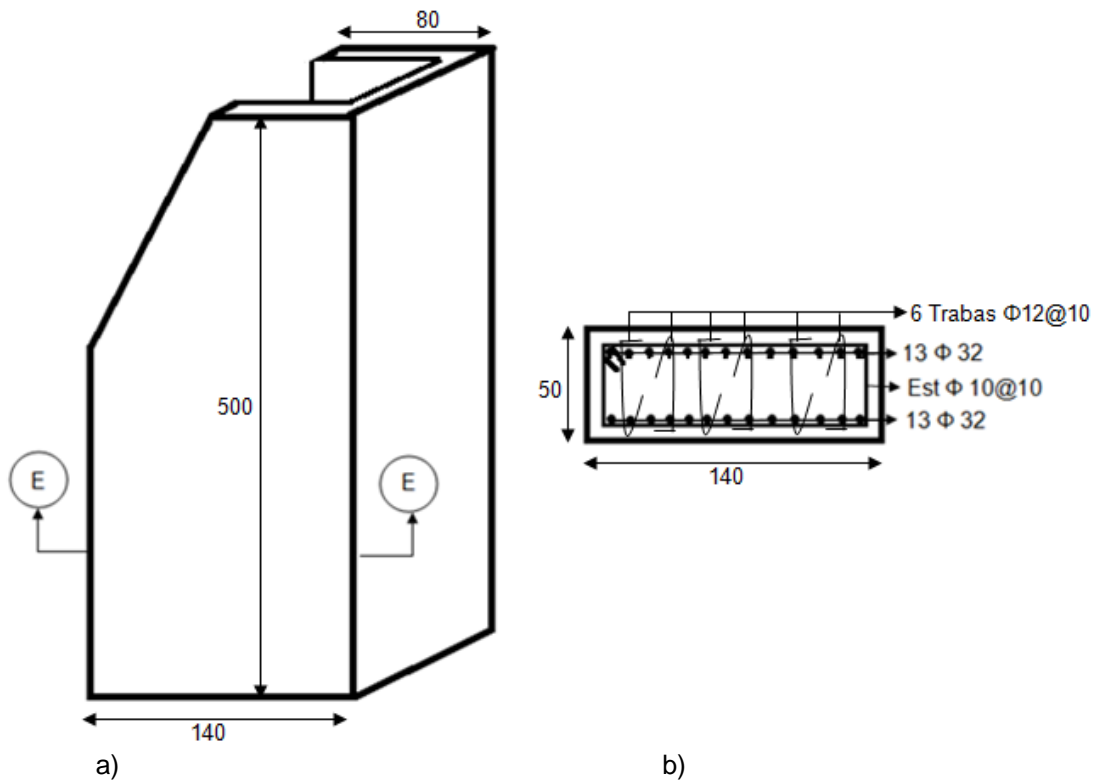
a) Vista lateral muro cerro. b) Sección E-E.
